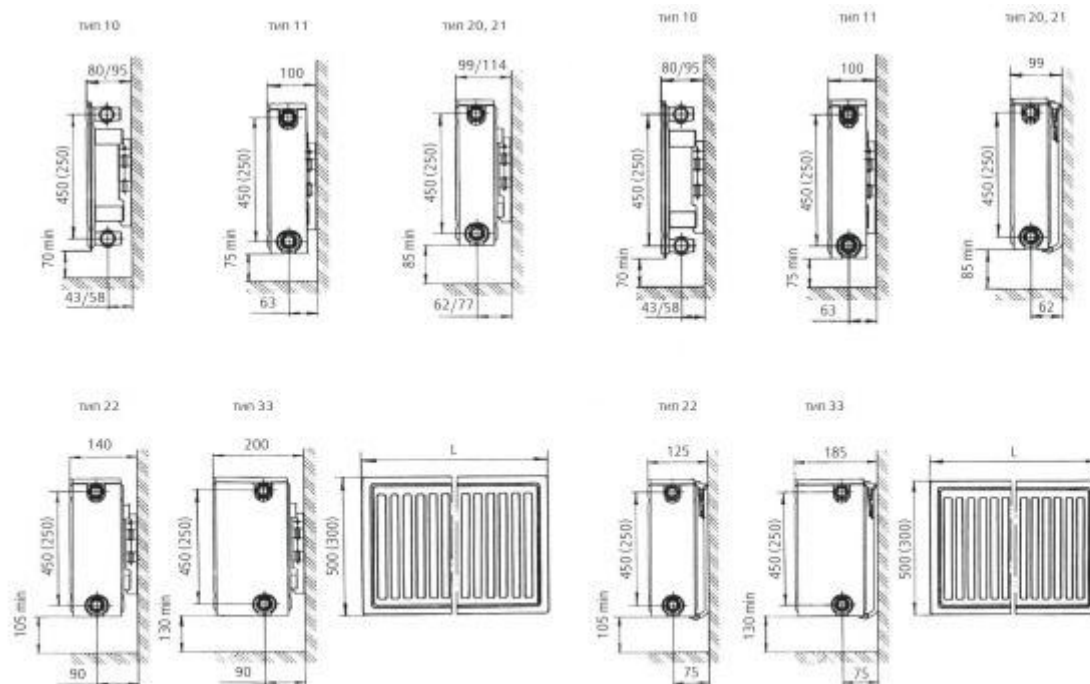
Общий вид и габаритные размеры радиаторов «PRADO Classic»
